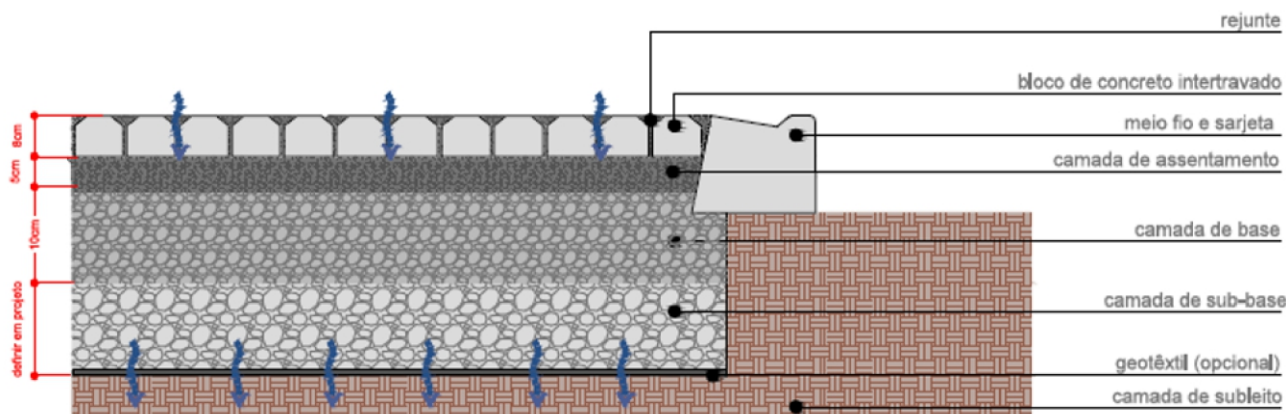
Corte transversal de um pavimento em blocos de concreto.
